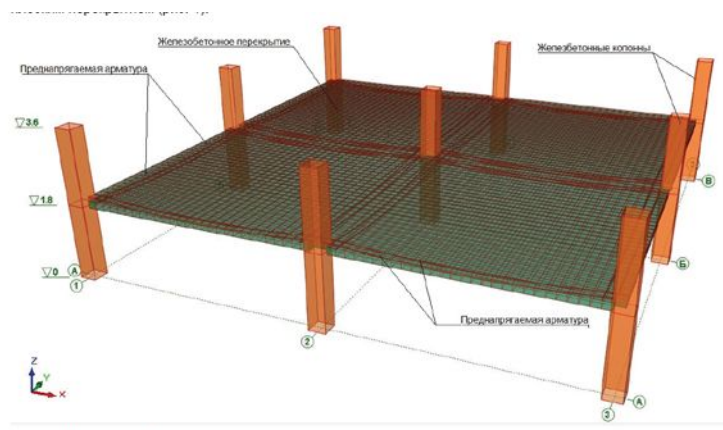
Безригельный каркас с предварительно напряженной плитой перекрытия
